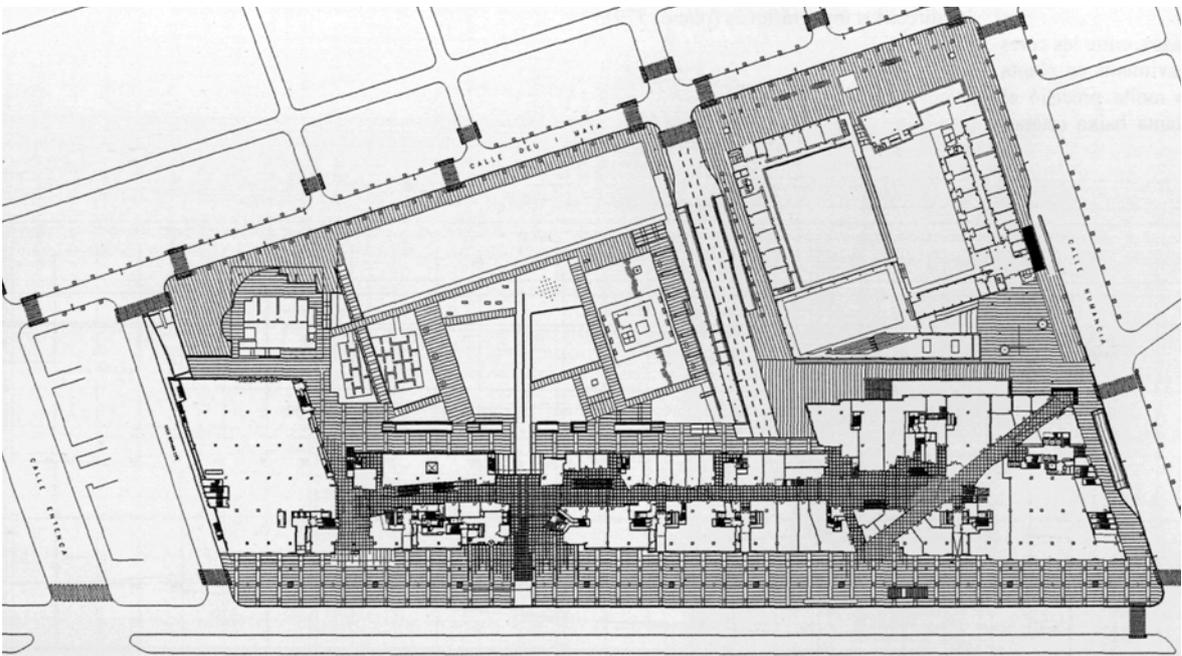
Planta baja y de pavimentos, proyecto ejecutivo L'illa Diagonal.
